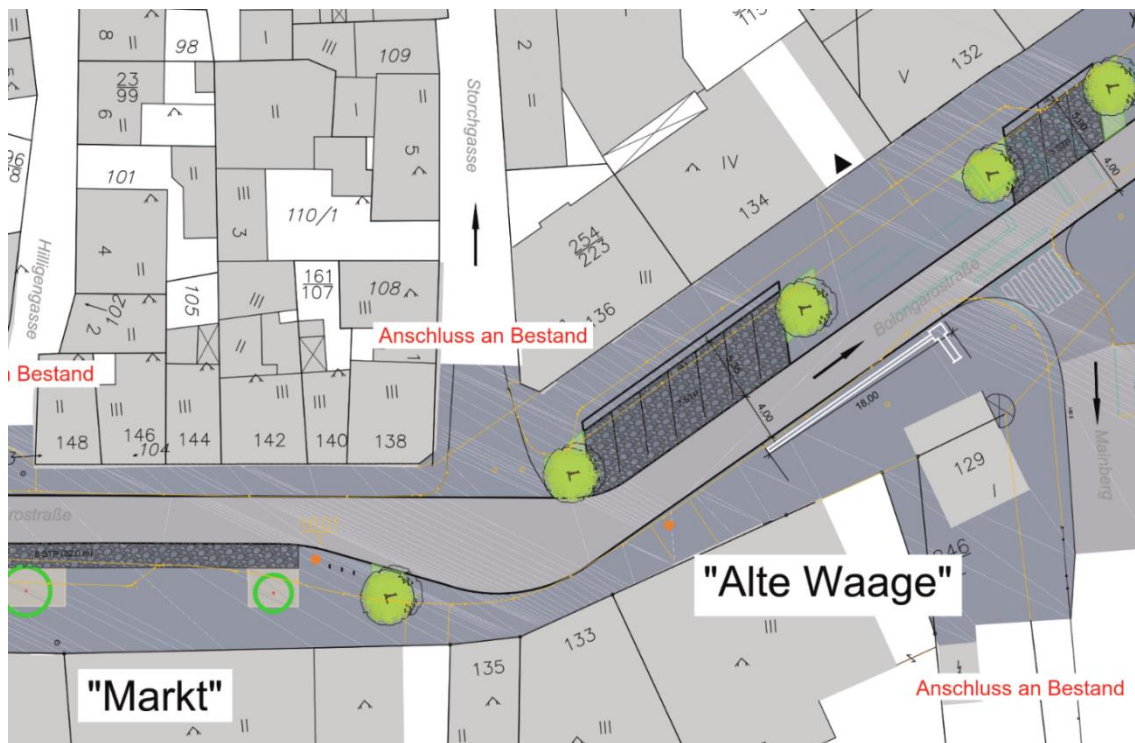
Ausschnitt Planung Umgestaltung Bolongarostraße (Quelle: Stadtplanungsamt)
